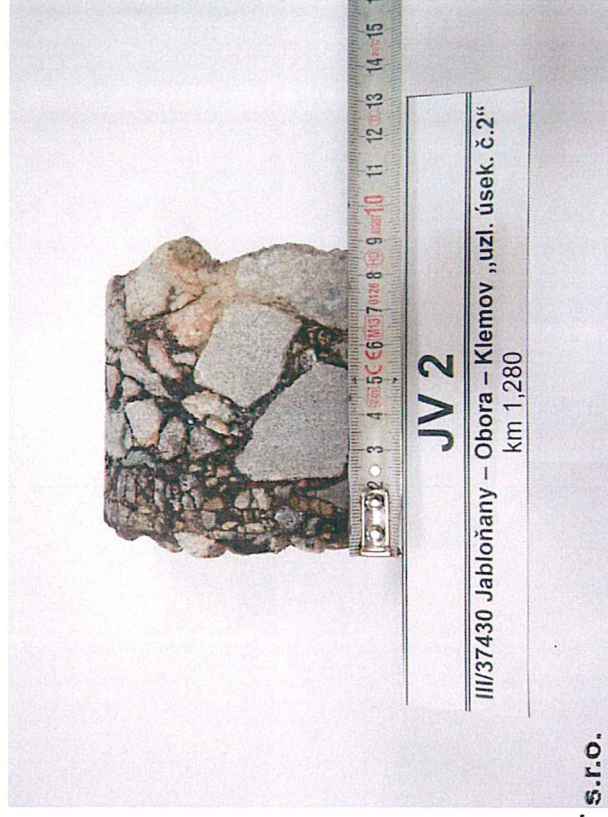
Detail vývrtnu JV 2 (úsek č.2)
